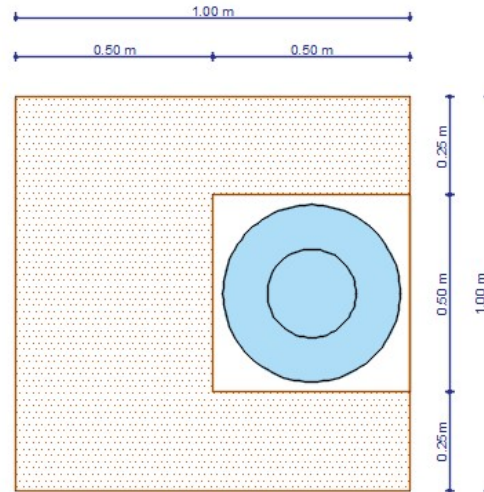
Vista en planta de la calicata, pozo de ensayo e infiltrómetro
